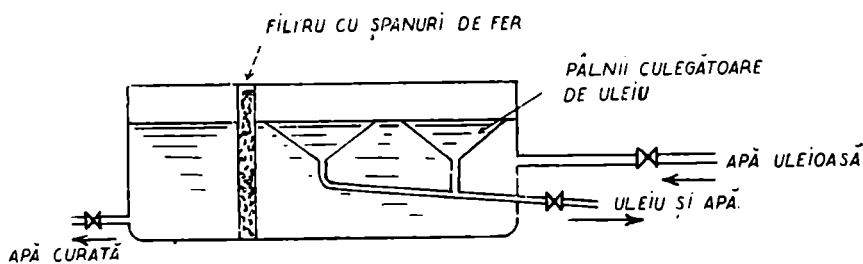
Instalație de desuleiere prin pâlnii de suprafață și filtru
